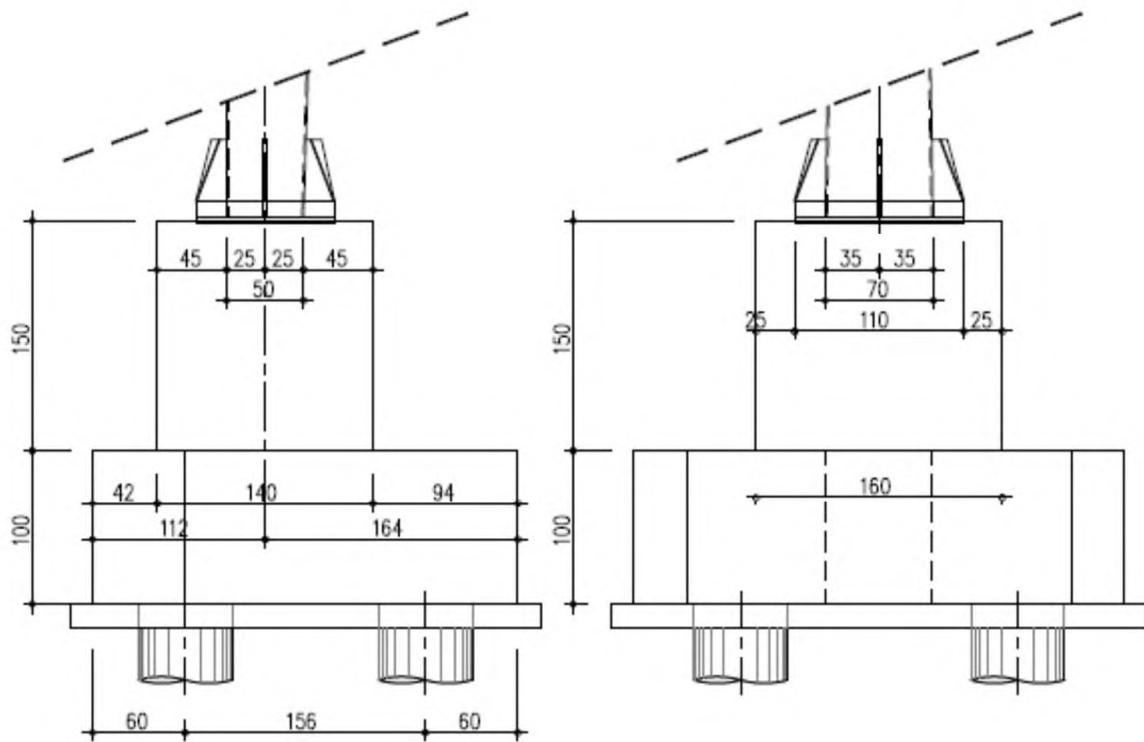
Sezioni del plinto di fondazione - posa su rilevato
